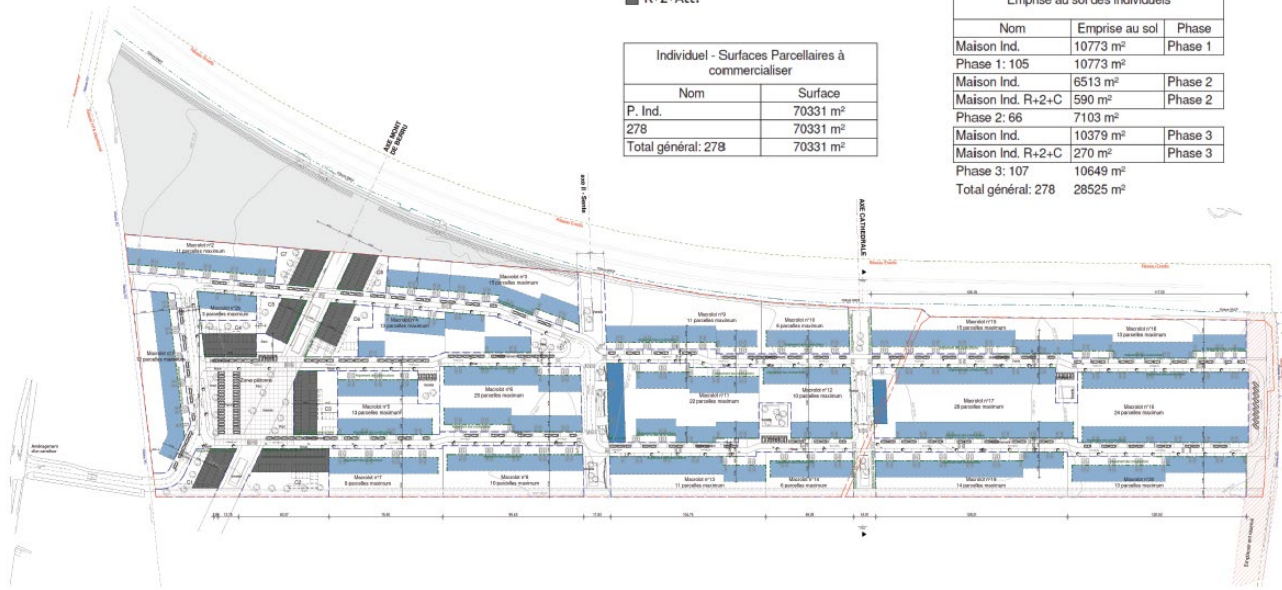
Plan d'implantation des futures constructions - Source SAS Bonne Nouvelle
